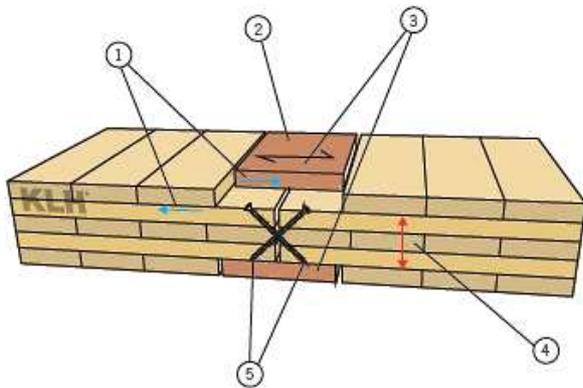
Ligação paredes exteriores (ligação placa metálica e parafusos roscados) [24]
